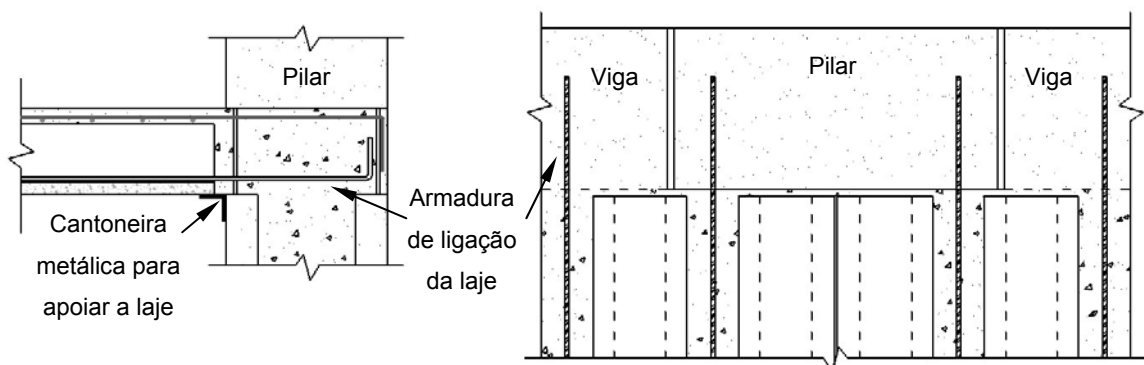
Ligação laje – pilar com continuidade de armaduras
